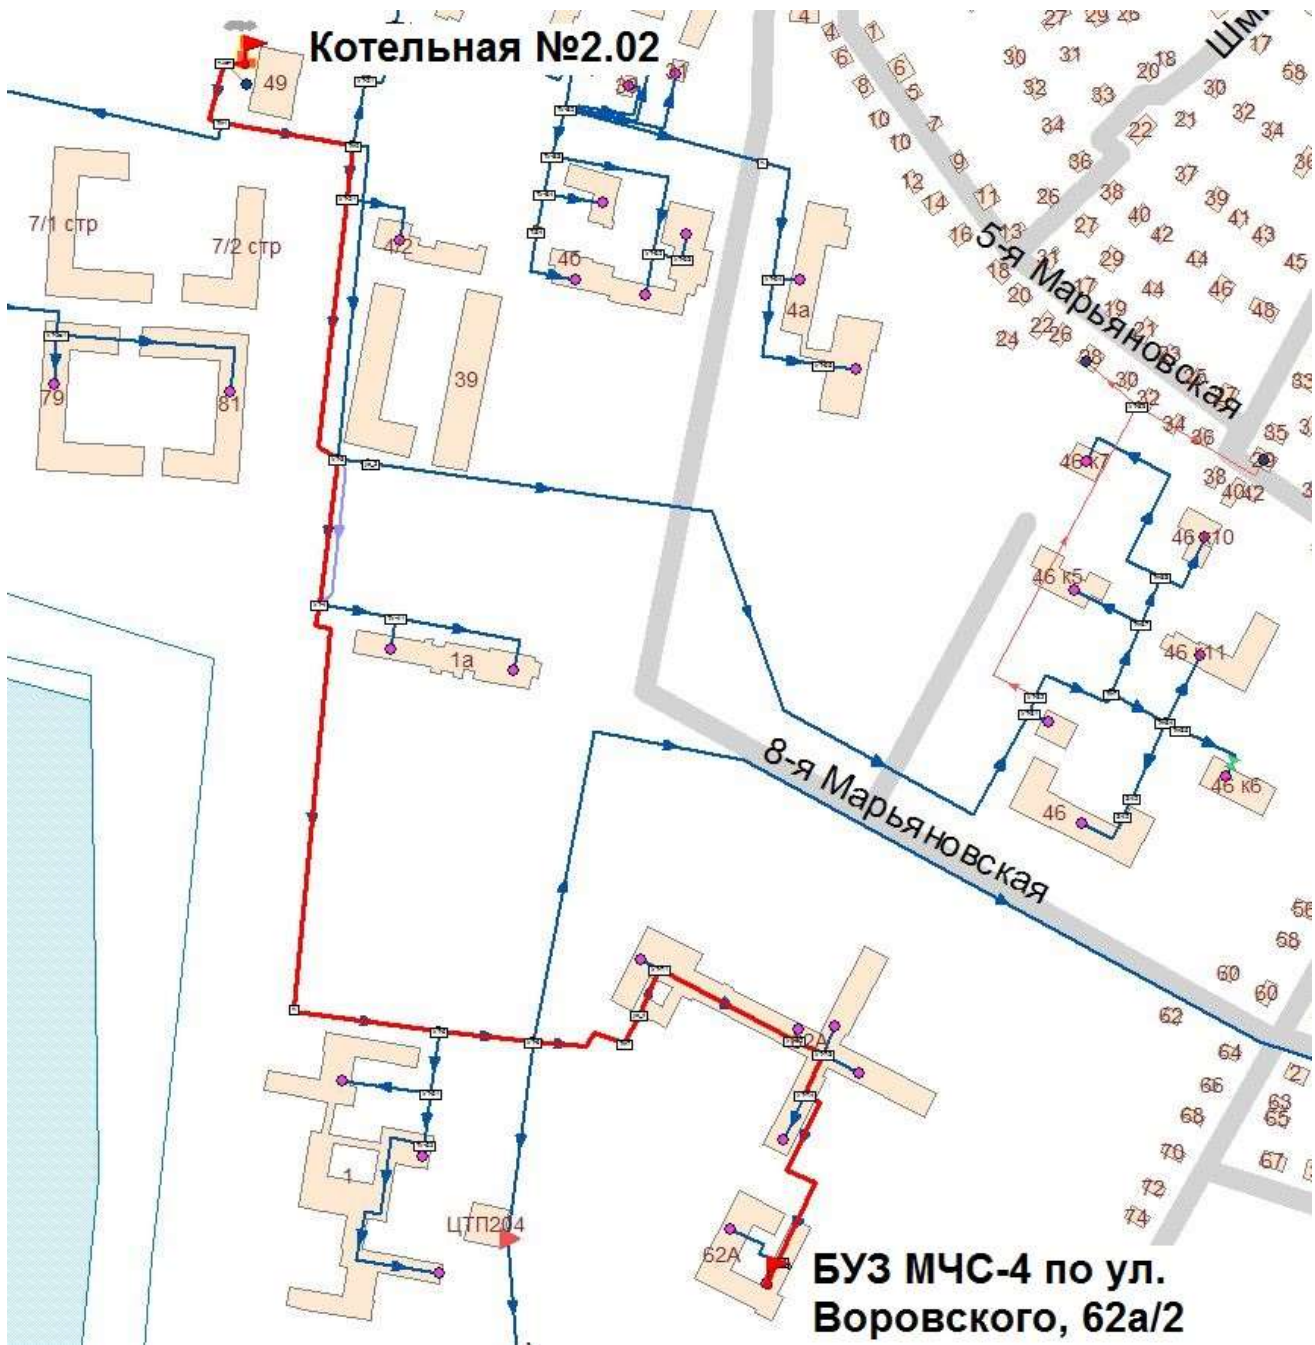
Трассировка теплопровода от Котельной 2.02 до БУЗ МЧС-4 по ул. Воровского, 62а/2
